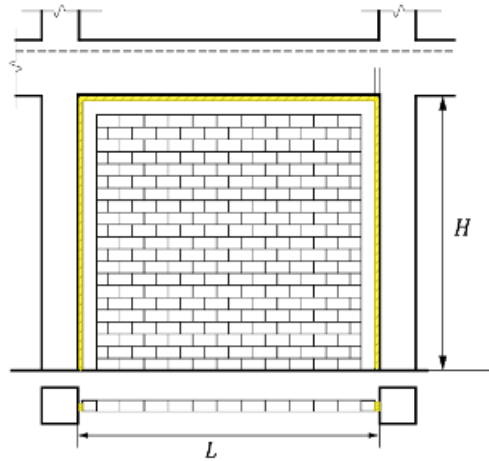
Localización de Celotex entre elementos estructurales y muro no estructural.³
